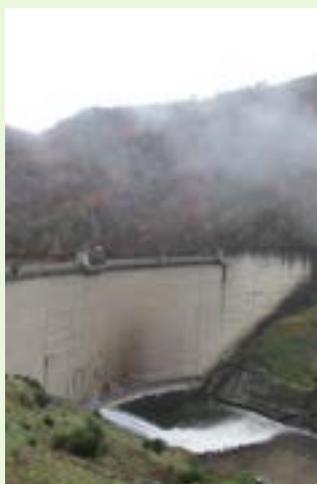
Barrage de Hautefage, photo prise sur site, ©BIOTOPE
